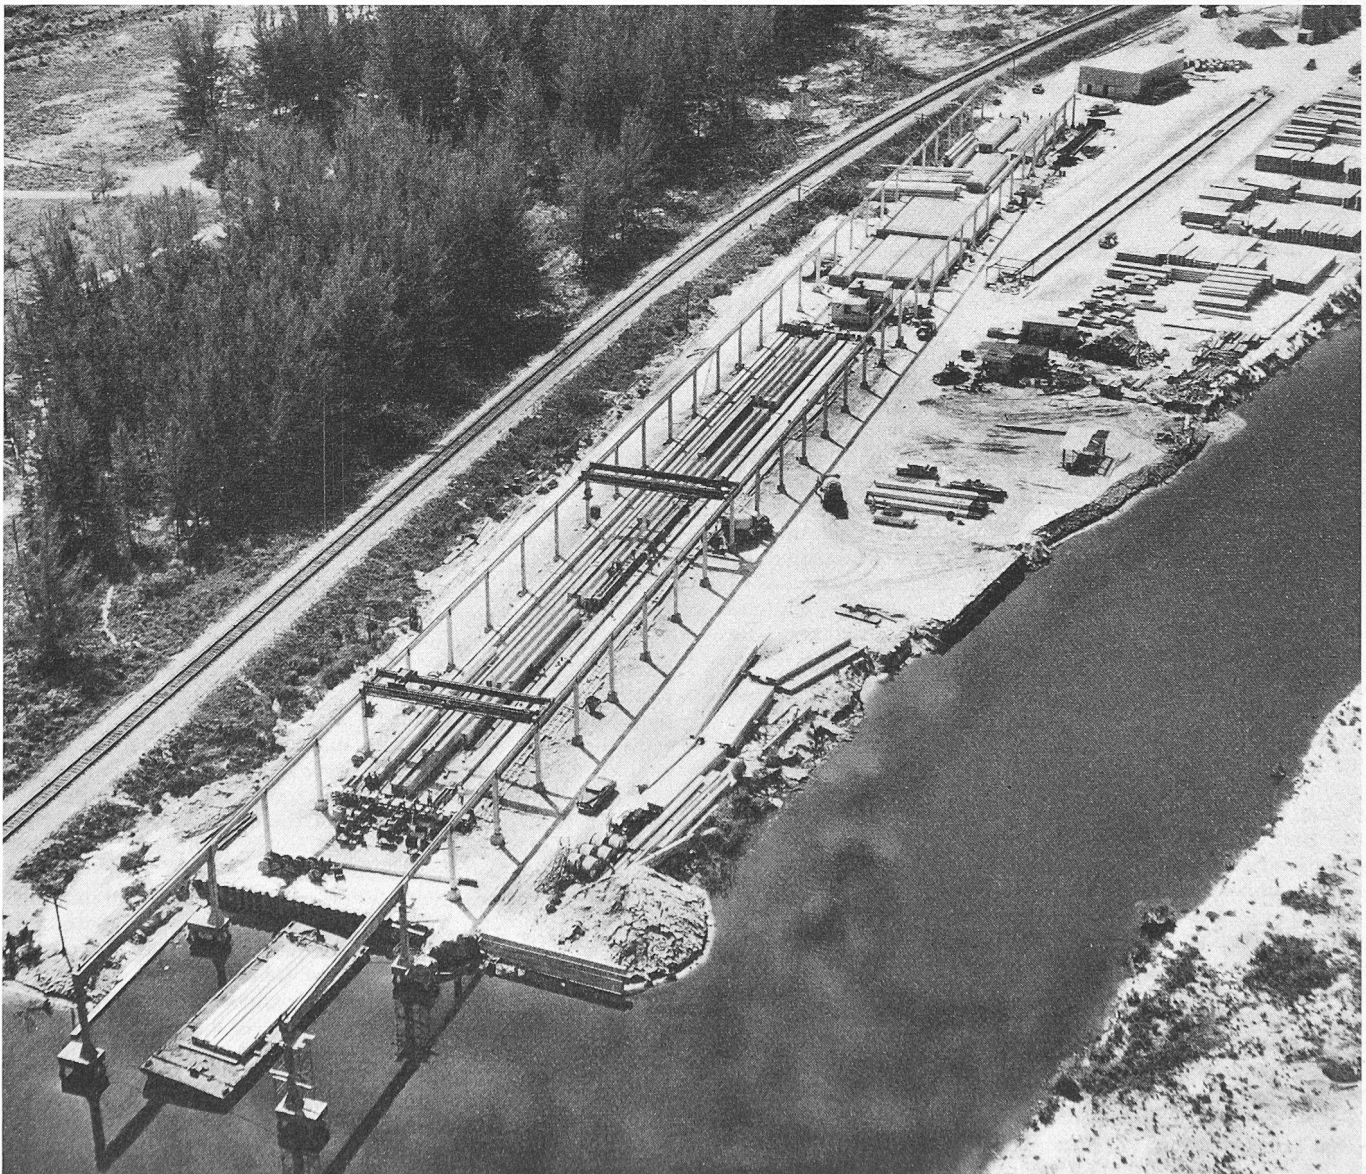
Spannbetonfabrik in Florida mit Wasserladefront. Photo R. H. Wright & Son, Fort Landerdale, Florida
